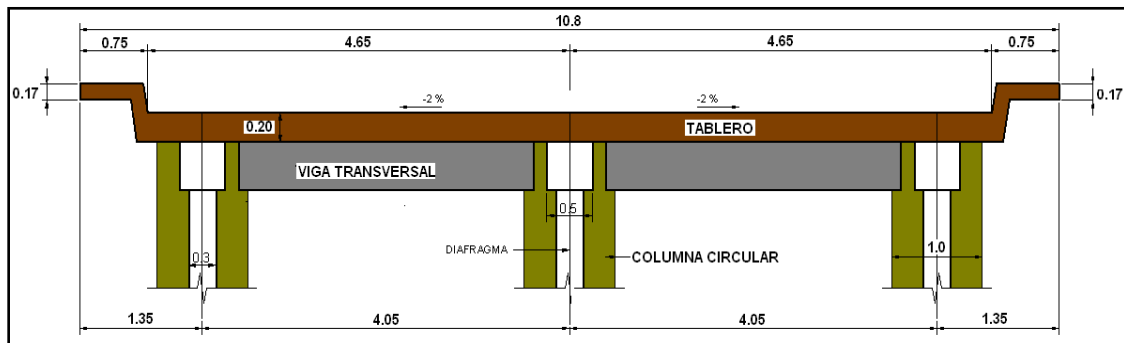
Sección transversal de vigas de arriostramiento. (CEE, 2009)
